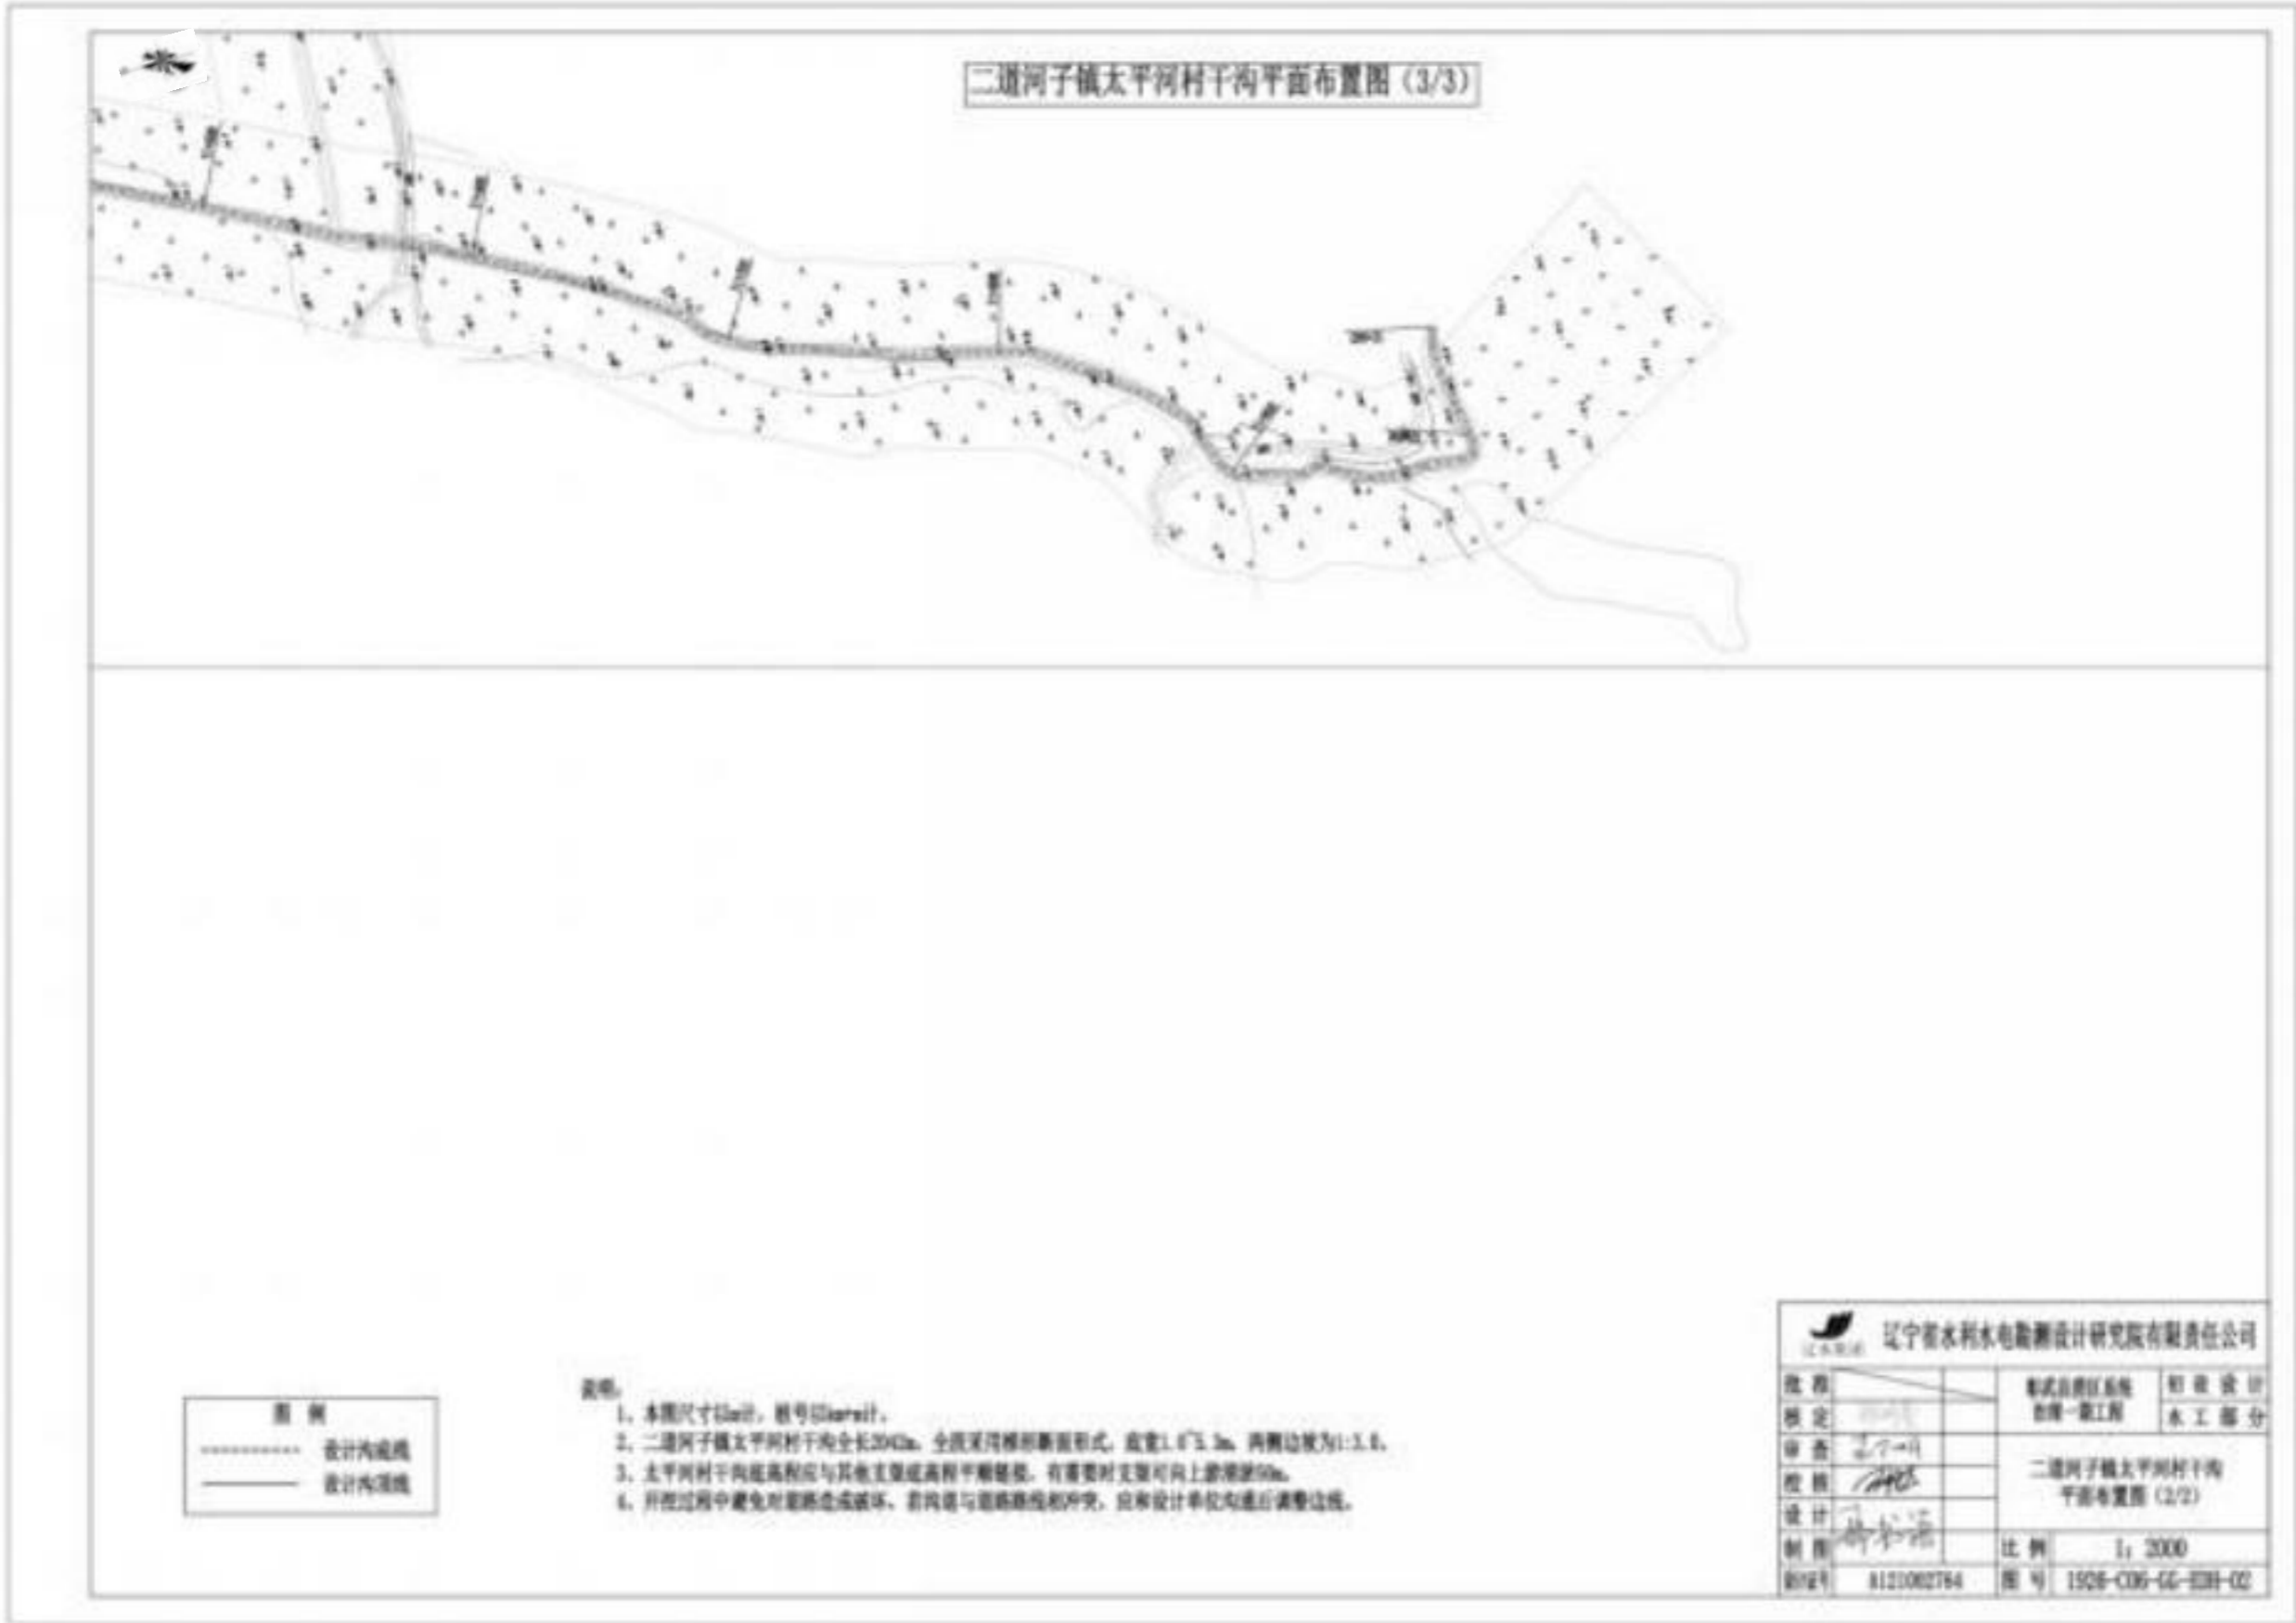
(2) 二道河子乡太平河村干沟平面布置图
